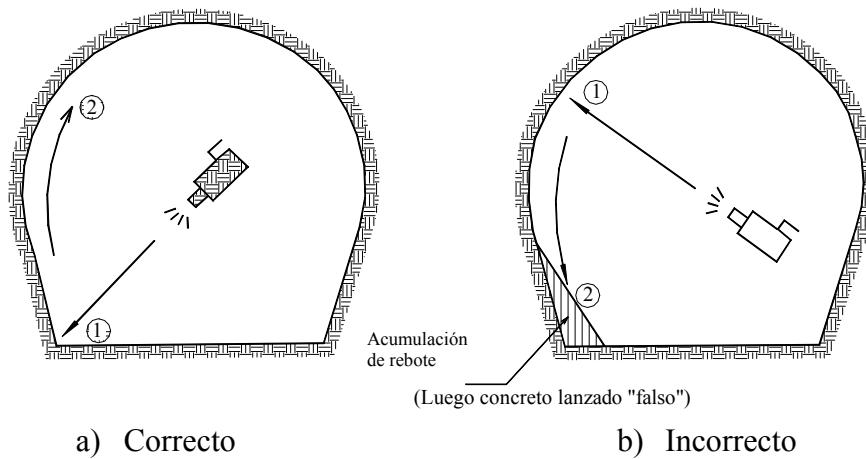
18 Secuencia de aplicación del concreto lanzado.
